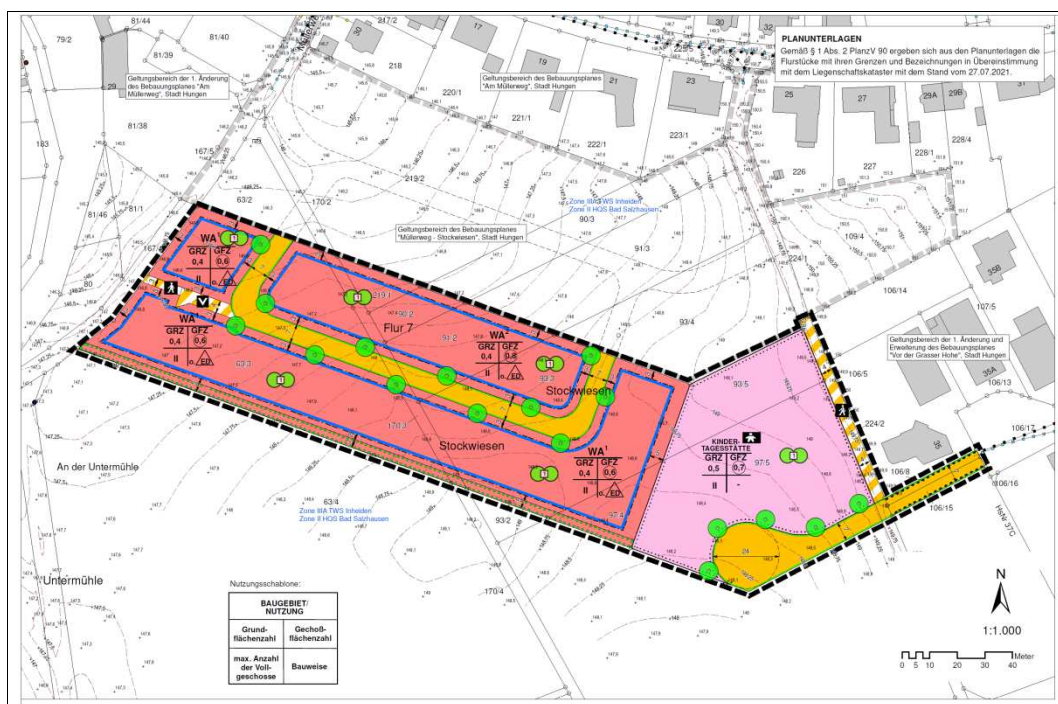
Bebauungsplan Nr. 1.37 "Müllerweg-Stockwiesen – 1. Änderung und Erweiterung".
